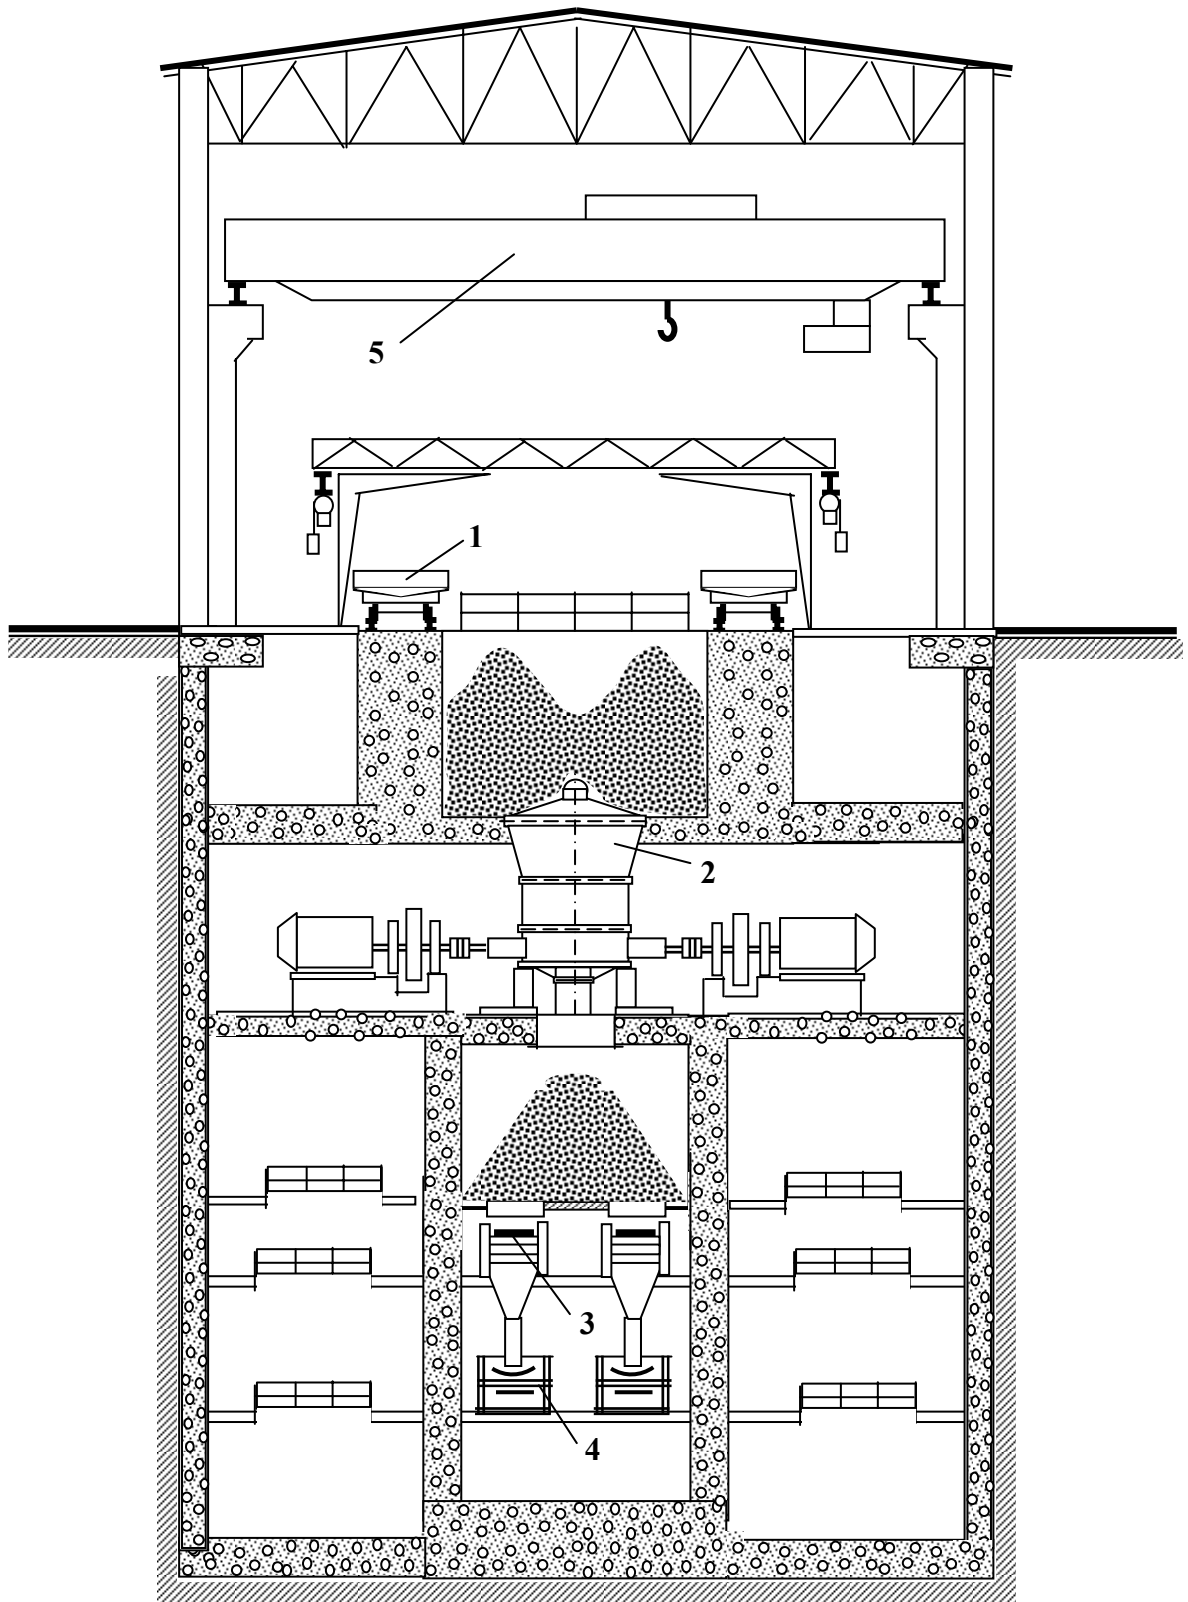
Корпус крупного дроблення з конусною дробаркою.
